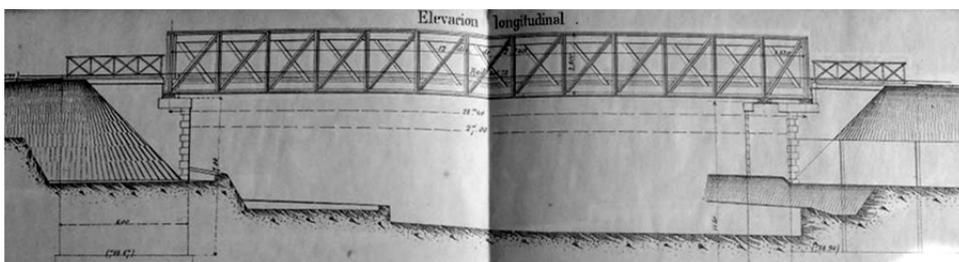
Viaducto de la Rambla de Gèrgal. Configuración de las vigas (detalle del tramo central), 1891
